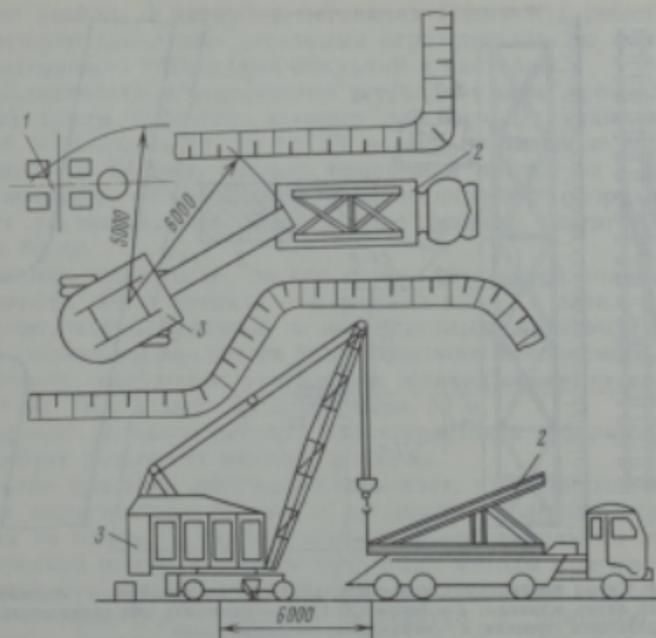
Монтаж металлической опоры эстакады стреловым краном «с колес»: 1 — место установки опоры СО-18; 2 — элемент опоры; 3 — пневмоколёсный кран
